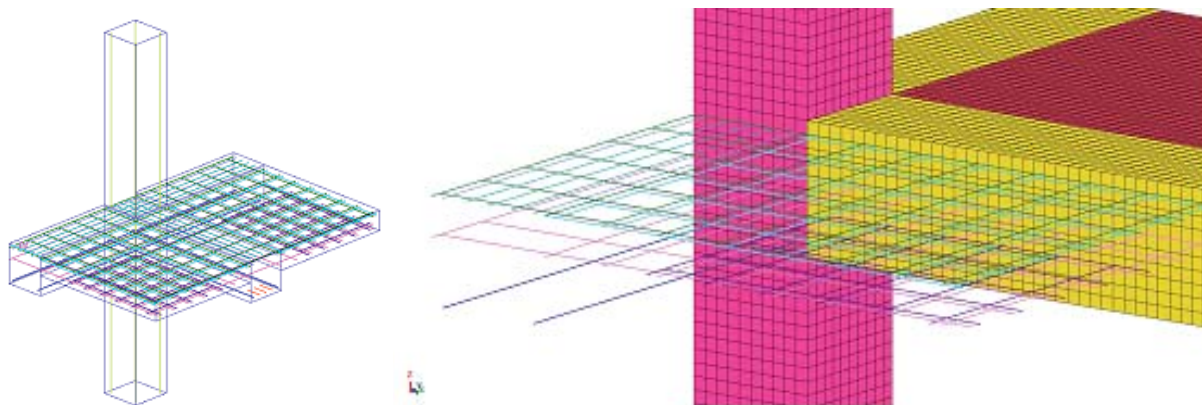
Армирование узла сопряжения колонны, балки и плиты ребристой плиты перекрытия в расчетной модели
